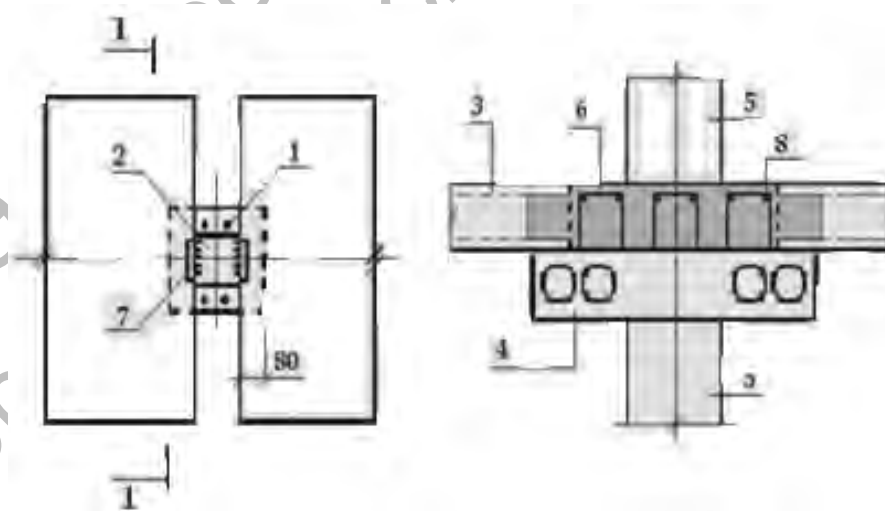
Стык колонны с плитным ригелем и плитами перекрытия: 1 – выпуски арматуры колонны; 2 – закладная деталь колонны; 3 – пустотная плита; 4 – сборный плитный ригель; 5 – колонна; 6 – бетон замоноличивания; 7 – закладная деталь плитного ригеля; 8 – надпорная арматура плитного ригеля
